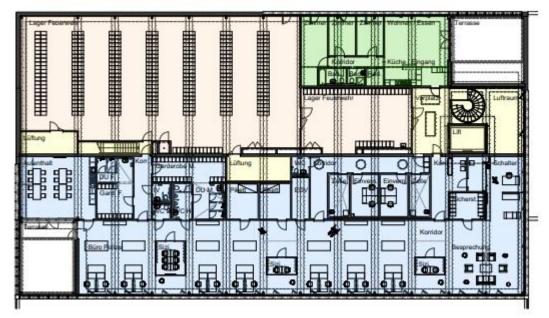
Grundriss 2. Obergeschoss (Stadtpolizei, Lager Feuerwehr, betriebszugehörige Wohnung)
